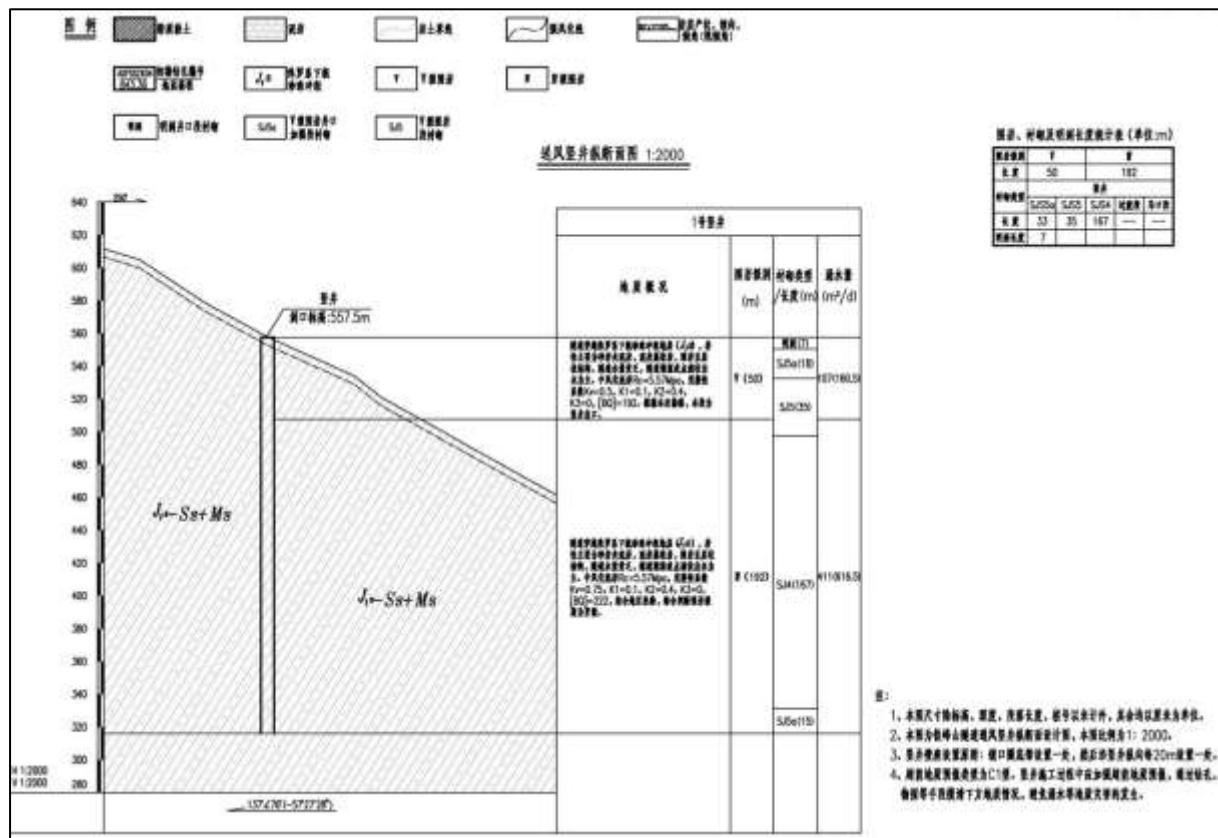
铁峰山隧道竖井纵断面布置示意图
